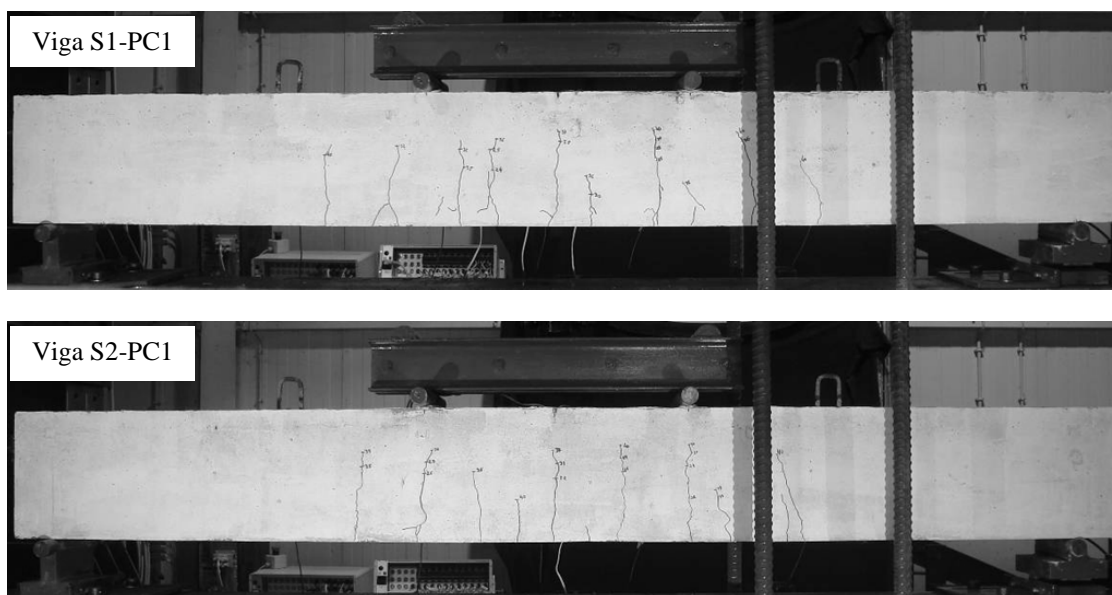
Padrão de fendilhação instalado nas vigas após a realização dos ensaios de pré-fendilhação (ensaio tipo I).
